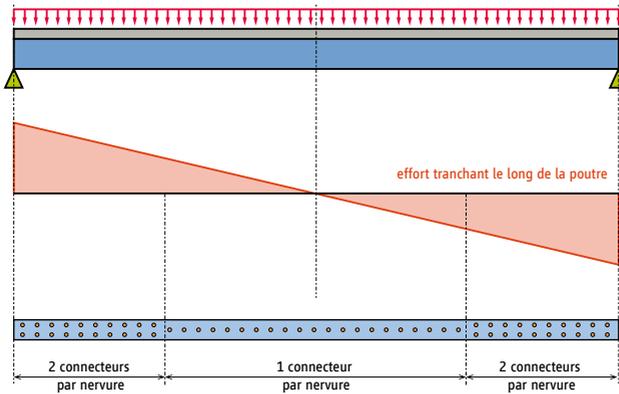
Exemple d'une poutre isostatique avec trois zones de connexion
